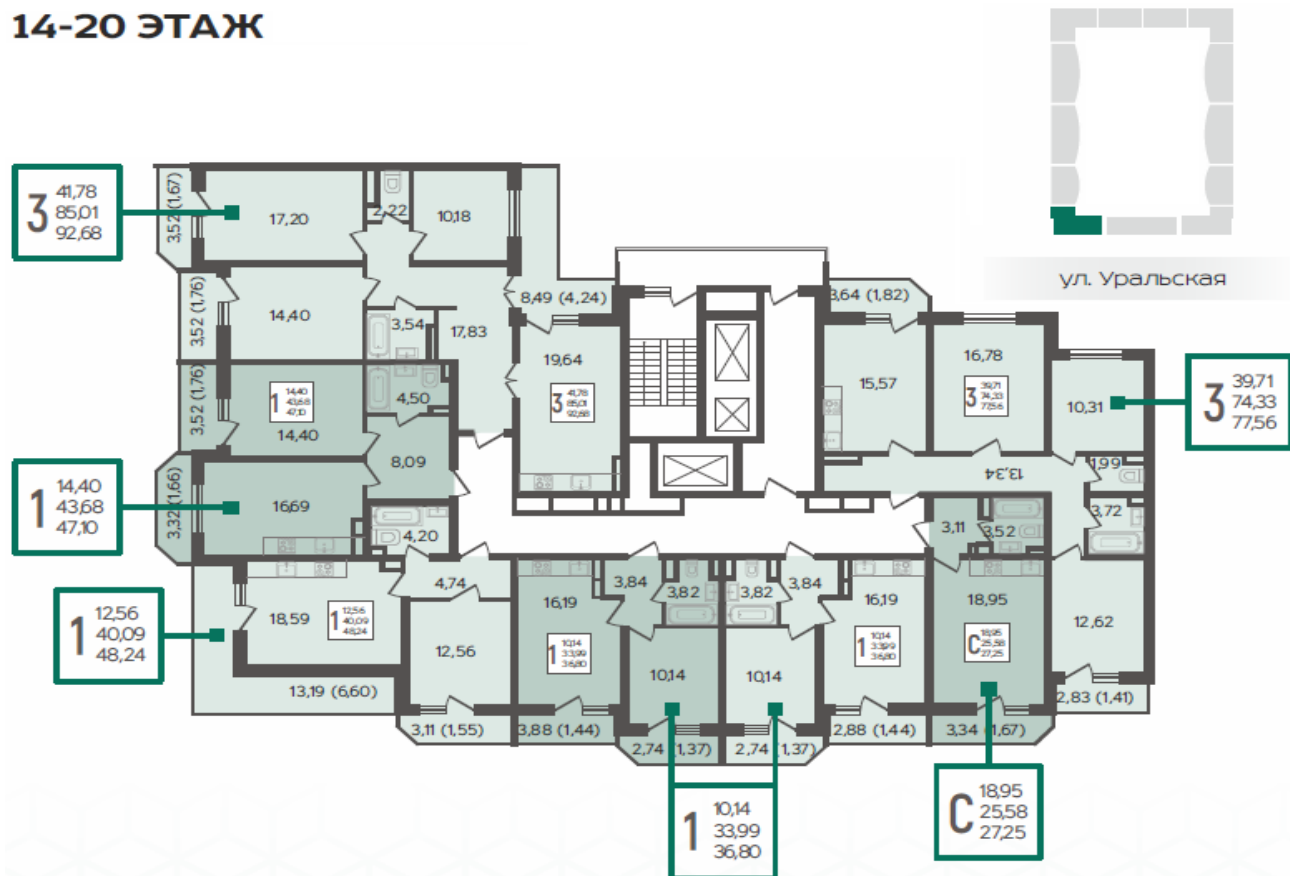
Типовой план 14-20 этажа БС-1 ЖК URAL
